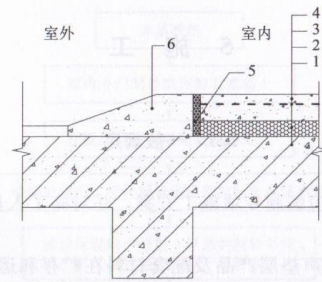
浮筑楼板与室外楼地面交接处构造 (剖面图)
